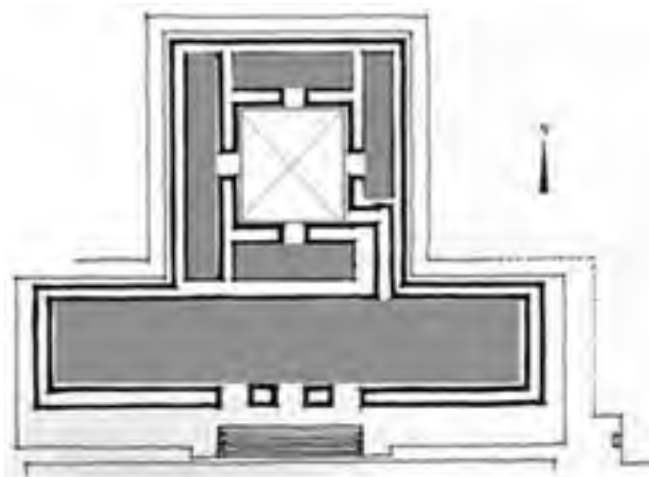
Planta arquitectónica del conjunto de Las Columnas en Mitla. Fuente: elaboración propia.
